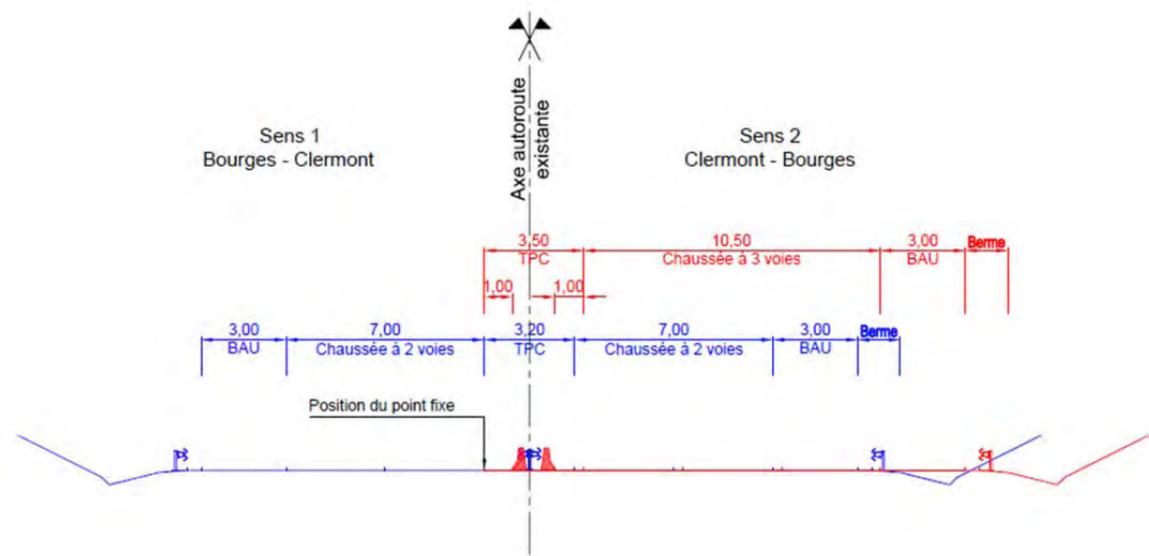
Profil en travers type de la zone d'élargissement par l'extérieur (en déblai avec double GBA centrale)
